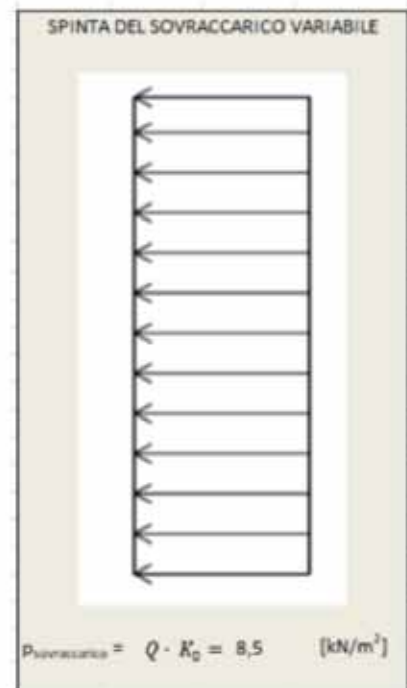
SPALLE A e B – Spinta sovraccarico variabile
